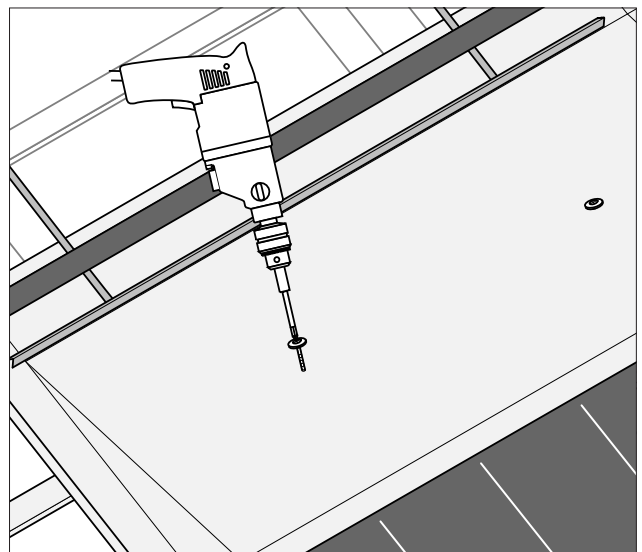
Jedes Abdeckblech zusätzlich mit je 2 Spengler-Dichtschrauben befestigen.
